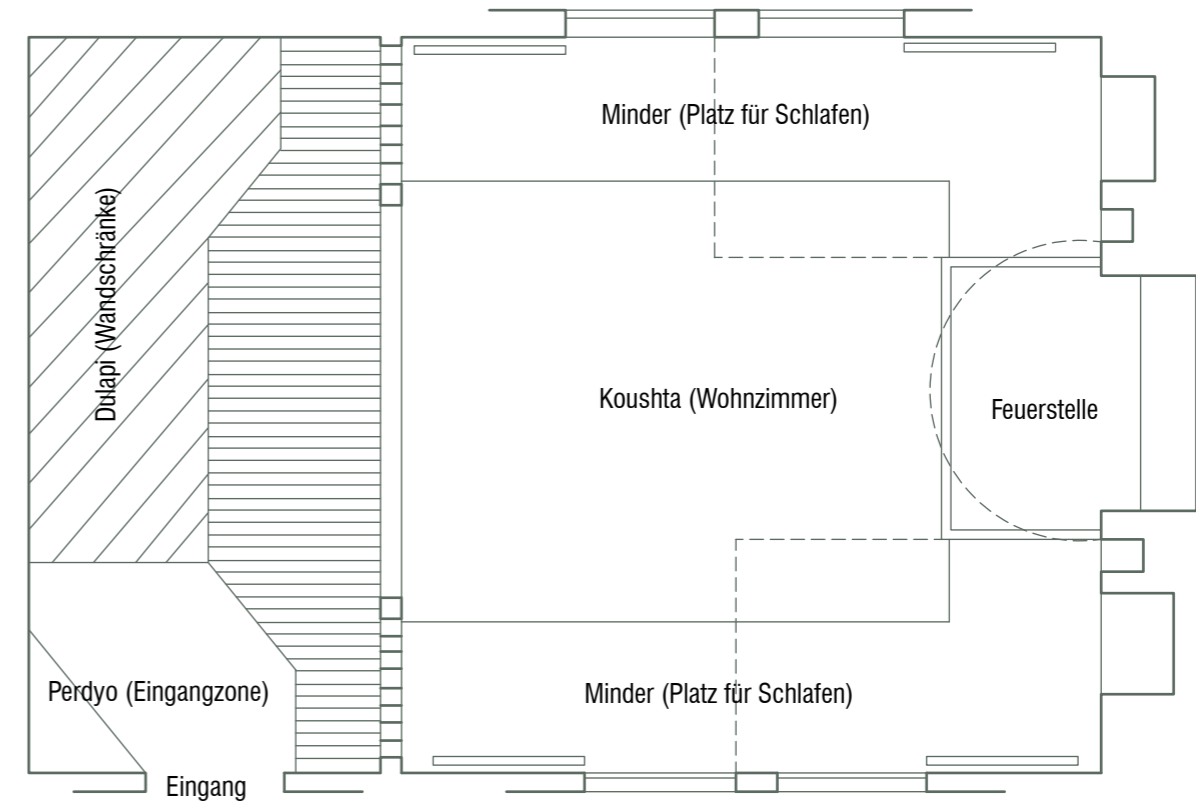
Koushta (Wohnzimmer) in den Konaks, Grundriss
